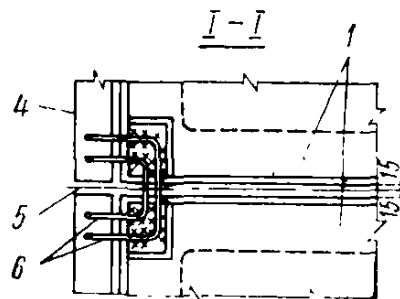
Опирание плит покрытия на стеновые панели резервуаров типа А
